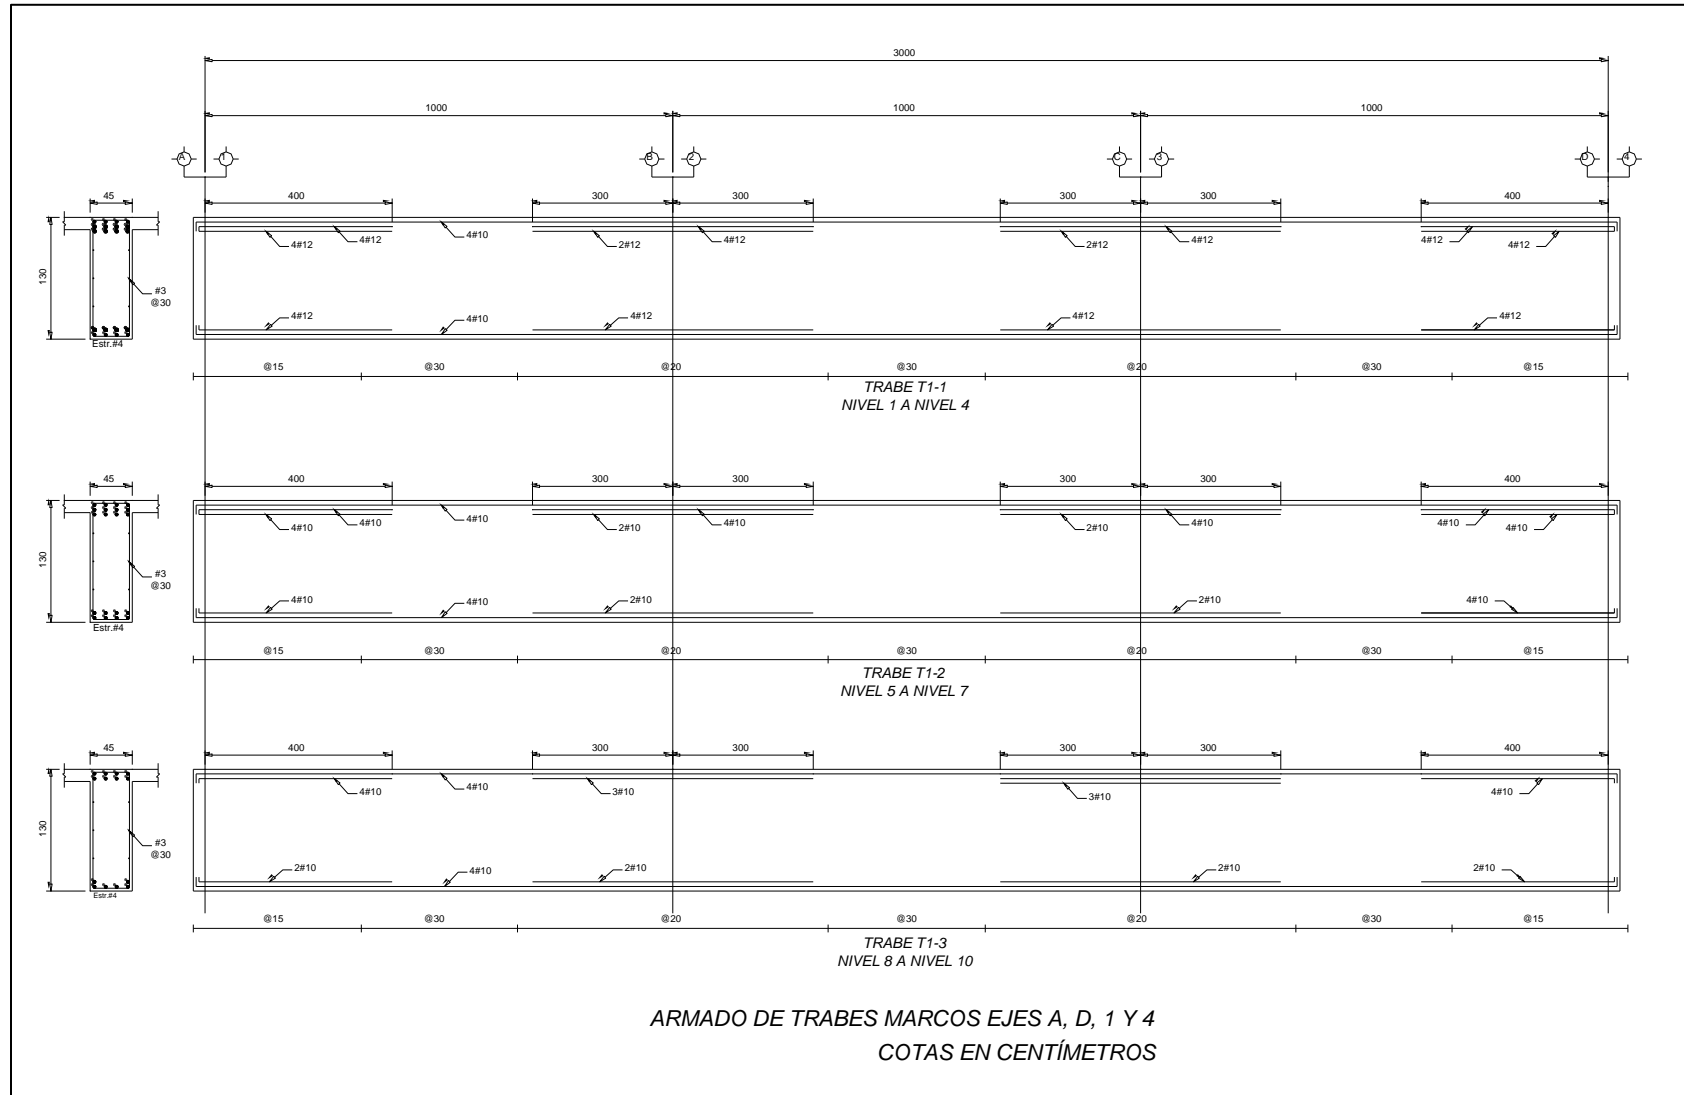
Detalles estructurales del edificio de 10 niveles diseñado con el ACI318-08
